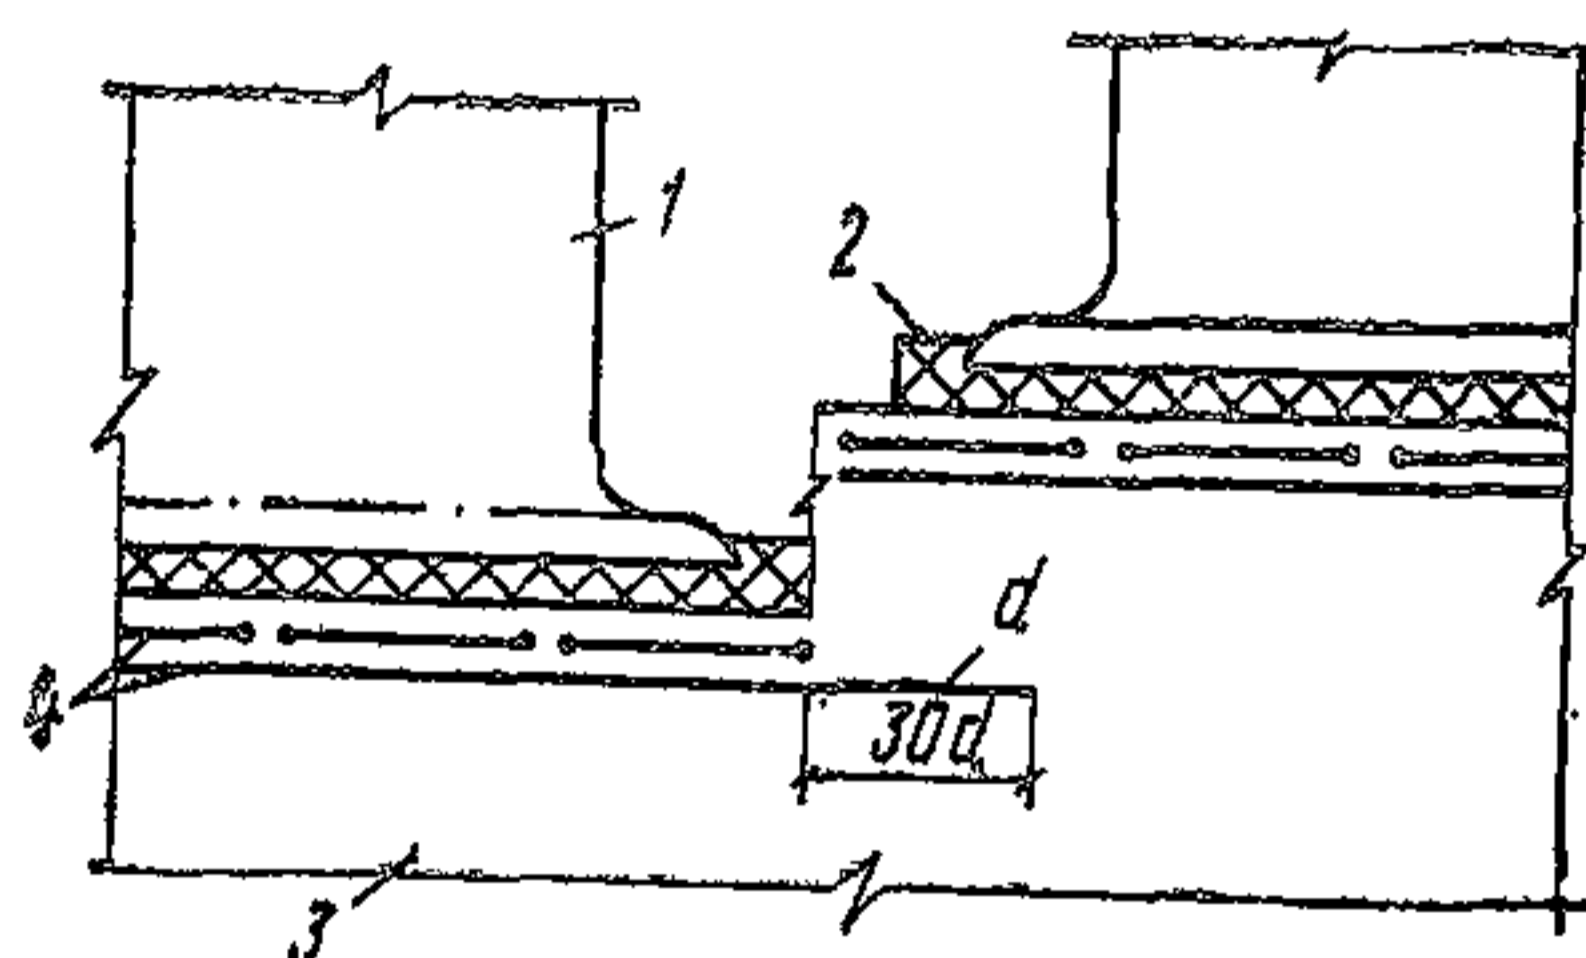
Армирование фундаментов под станинами оборудования при перепаде верхних отметок фундаментов
